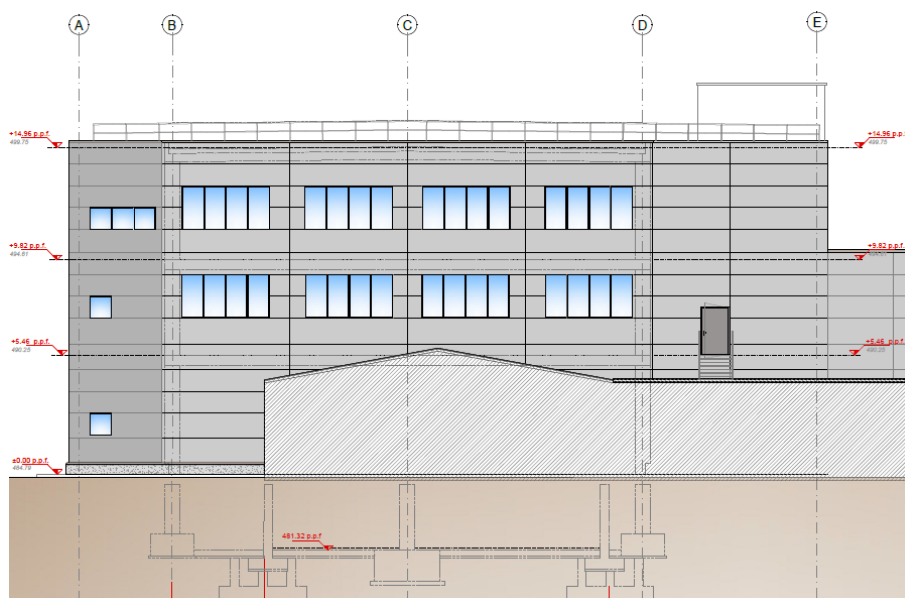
Prospetto Sud - Fabbricato Ex. Piemonte
